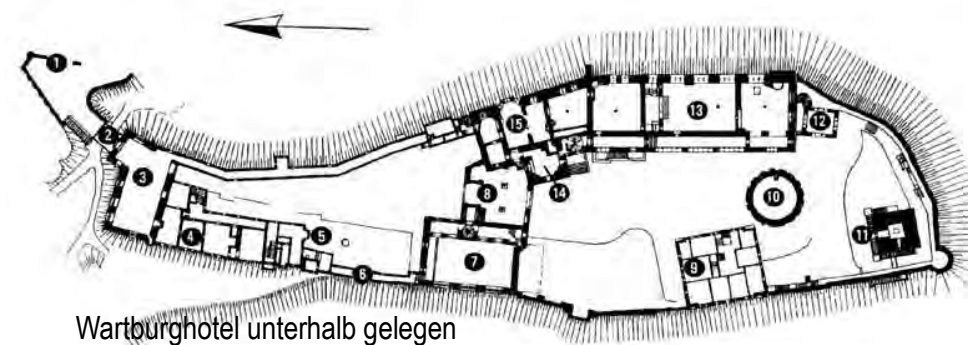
Grundriss der Wartburg (ohne Wartburghotel)
